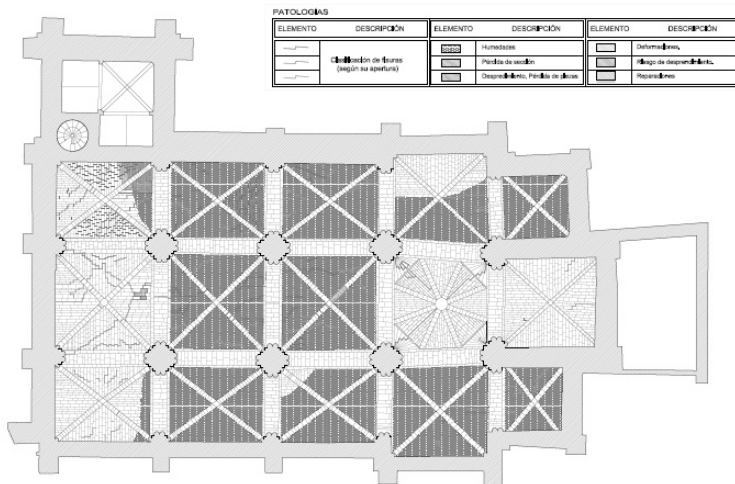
Plano de levantamiento patológico de las bóvedas de la Iglesia de Santa María la Mayor de Villamuriel de Cerrato (Palencia). Realizado por Tecnum.
